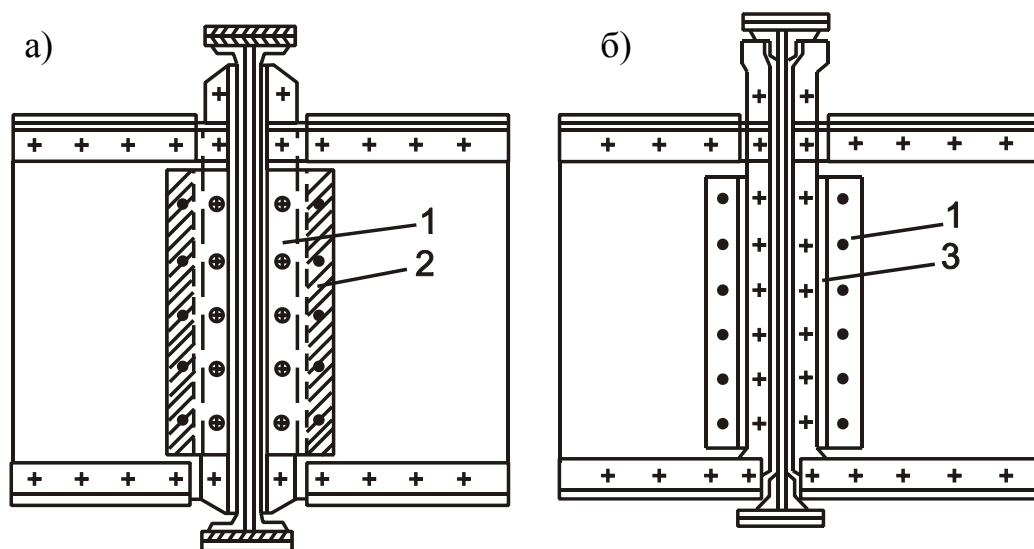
Схема усиления прикрепления продольных балок к поперечным путём увеличения числа заклепок и болтов: а — при помощи обычных накладок; б — при помощи приваренных накладок; 1 — накладка; 2 — прокладка; 3 — сварной шов;
